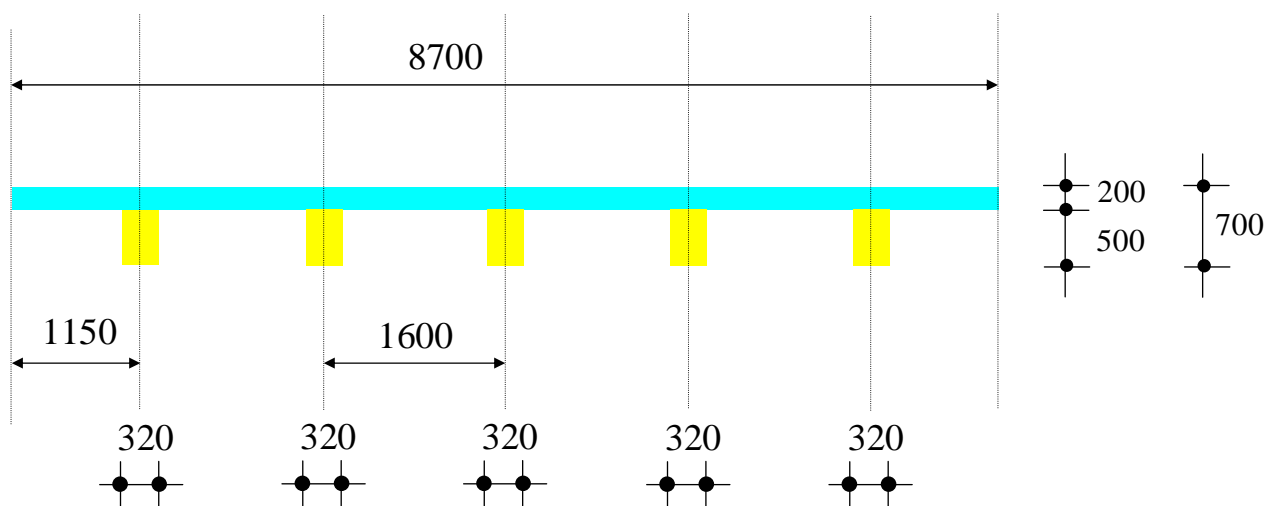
c: Sezione trasversale dell'impalcato del ponte, in campata, nello stato iniziale.
